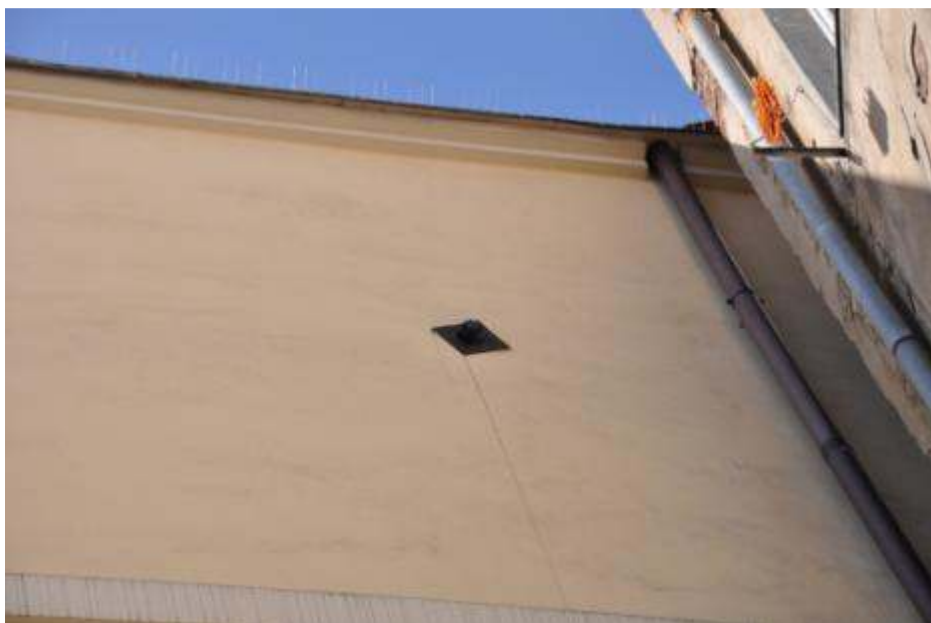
Fragment elewacji wschodniej: powyżej elewacja tynkowana; tynk o nierównej powierzchni; widoczna siatka rys;
